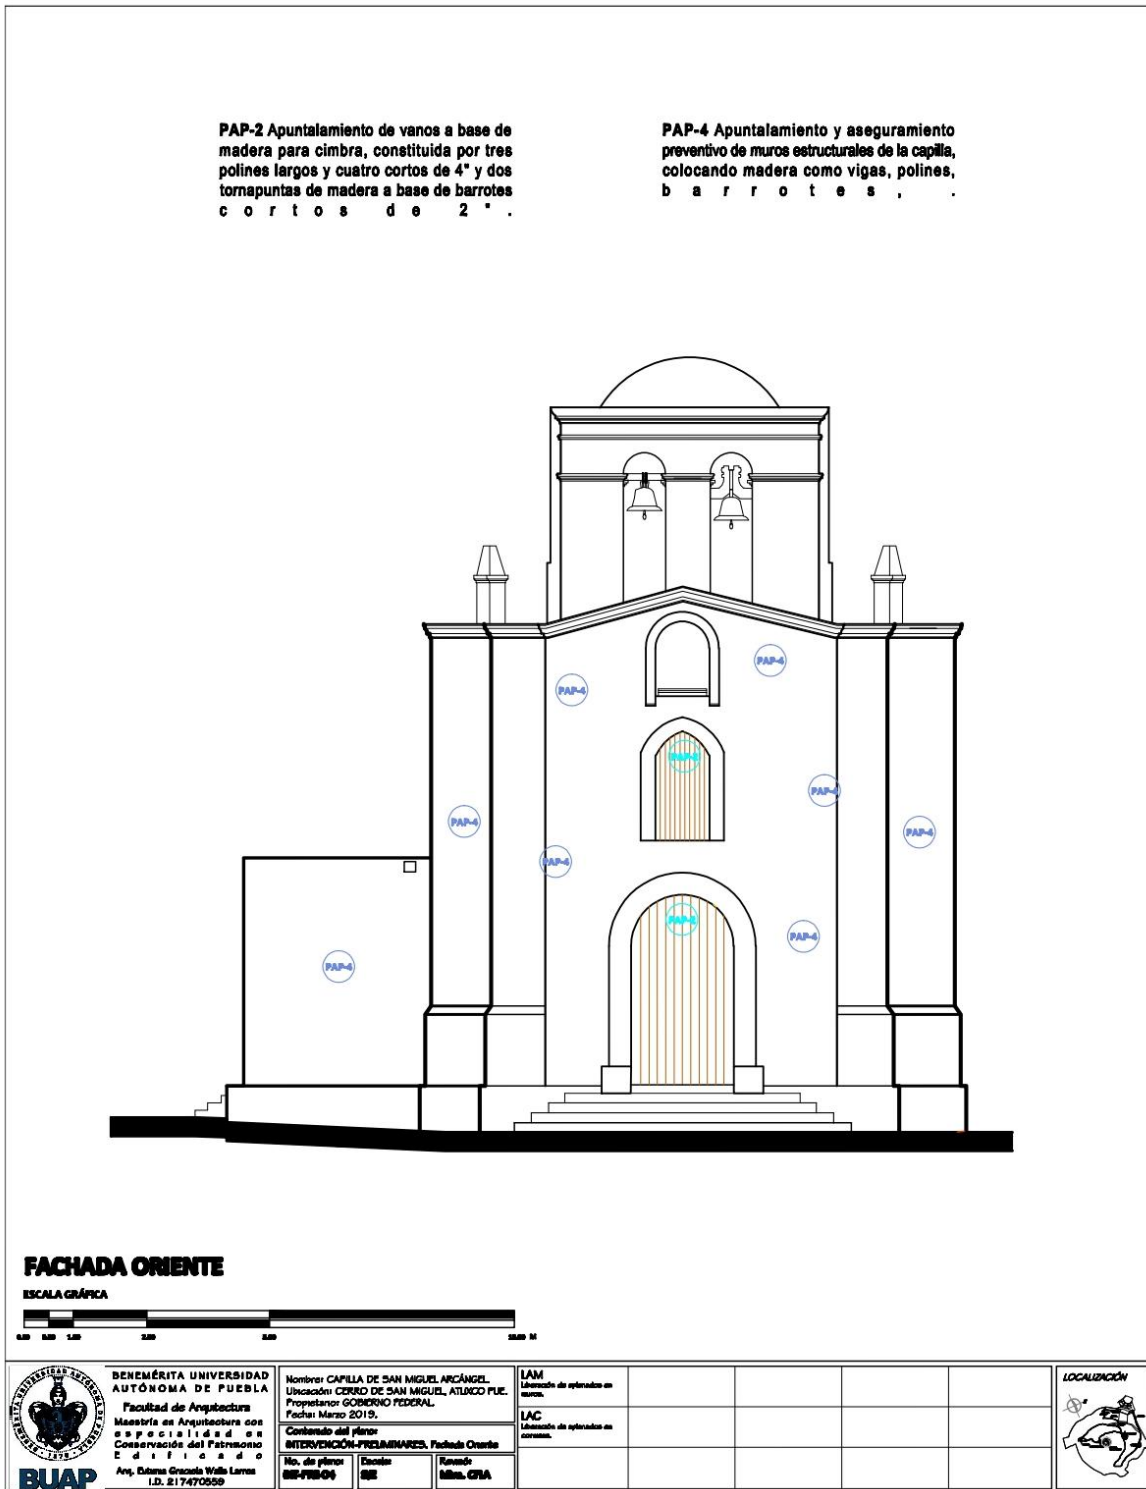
Plano 2 de intervención con acciones preliminares en la fachada oriente.
